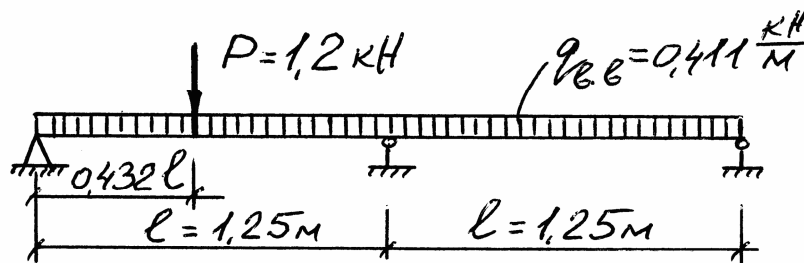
Розрахункова схема настилу при другому сполученні навантажень
